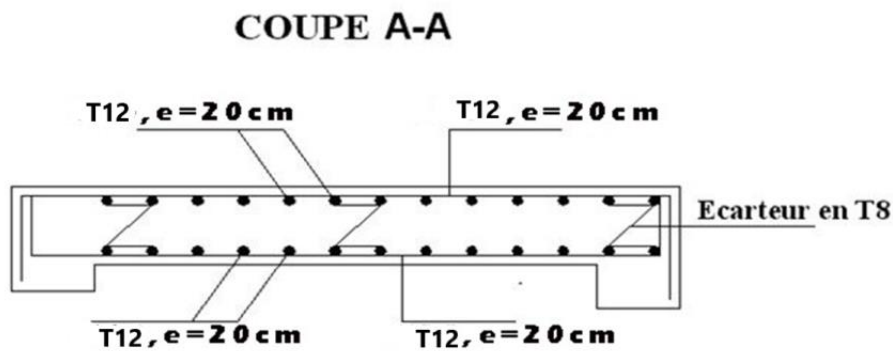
Disposition constructive des armatures de la dalle machine
